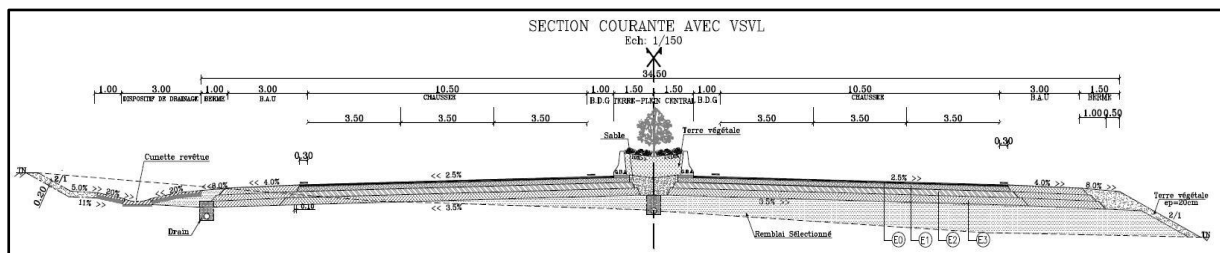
Profil en travers type - Section de l'autoroute avec VSVL
